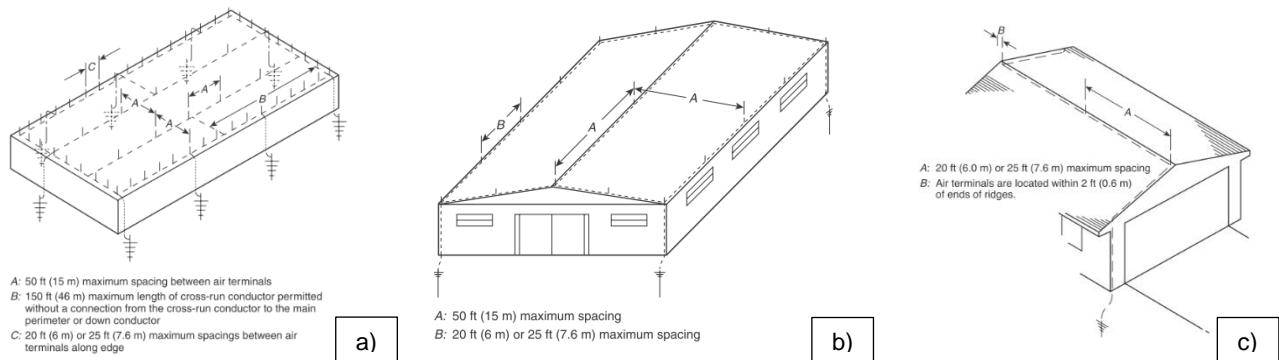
Métodos de cubierta a) cubierta plana, b) cubierta a dos aguas y c) cubierta con pequeña inclinación.
